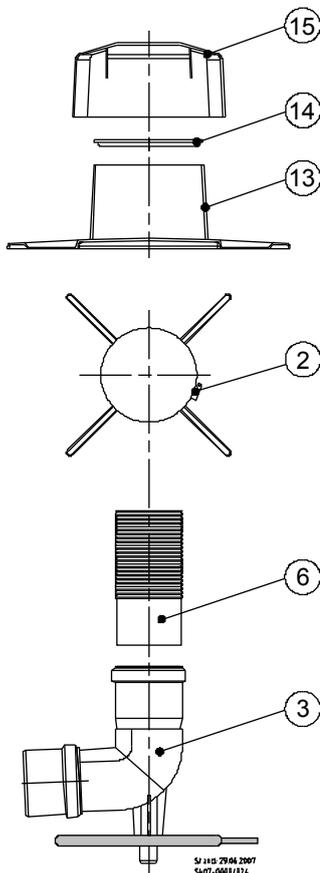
Detail-Zeichnung Befestigung Schachtabdeckung
